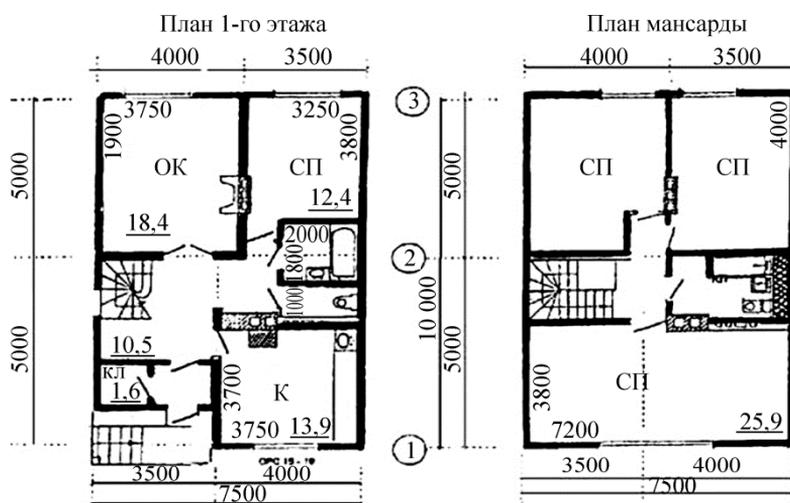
Планировка 1-го этажа и мансарды жилого дома ВАЛ 39-99 [7]
